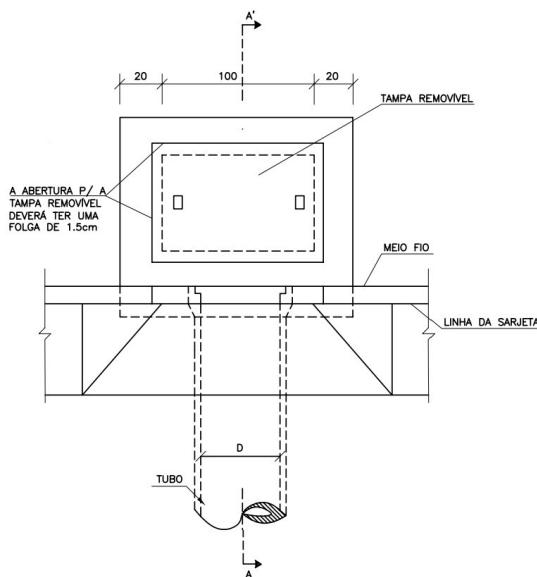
Planta baixa da boca de lobo do tipo guia chapéu com depressão (medidas em cm)
